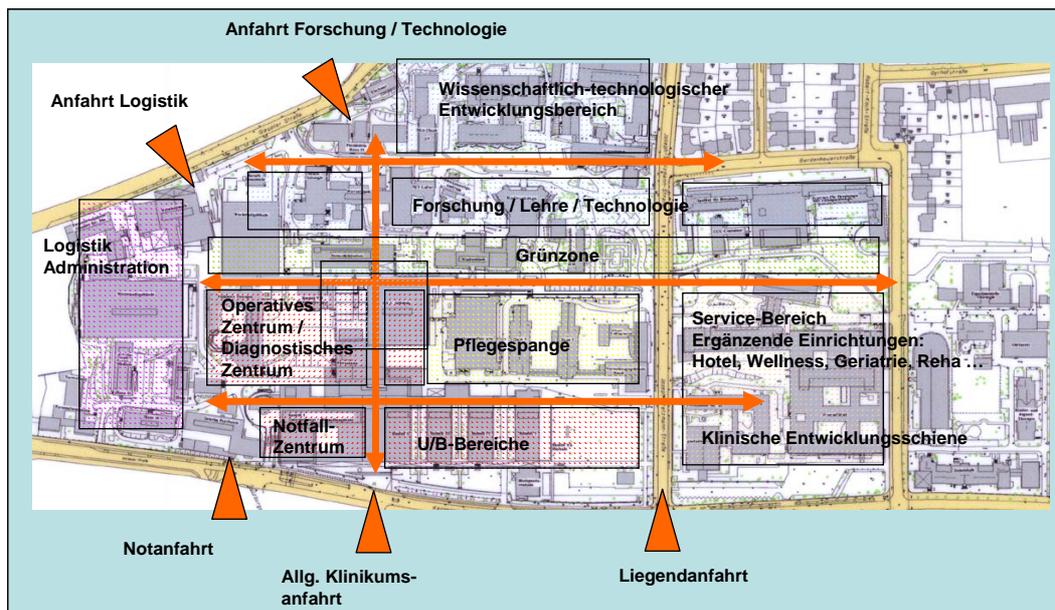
Lageplan mit Entwicklungsbereichen (Schema)
